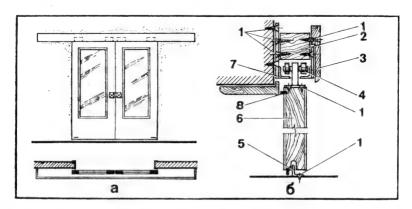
Раздвижные двери на верхней подвеске: а — общий вид двери; 6 — узлы и детали верхней подвески и нижней направляющей: 1 — шурупы; 2 — брус 50×55 мм; 3 — карниз; 4 — ролики; 5 — уголок $(18-20) \times (18-20)$ мм; 6 — дверное полотно; 7 — уголок 25×25 мм; 8 — резиновая полоса
